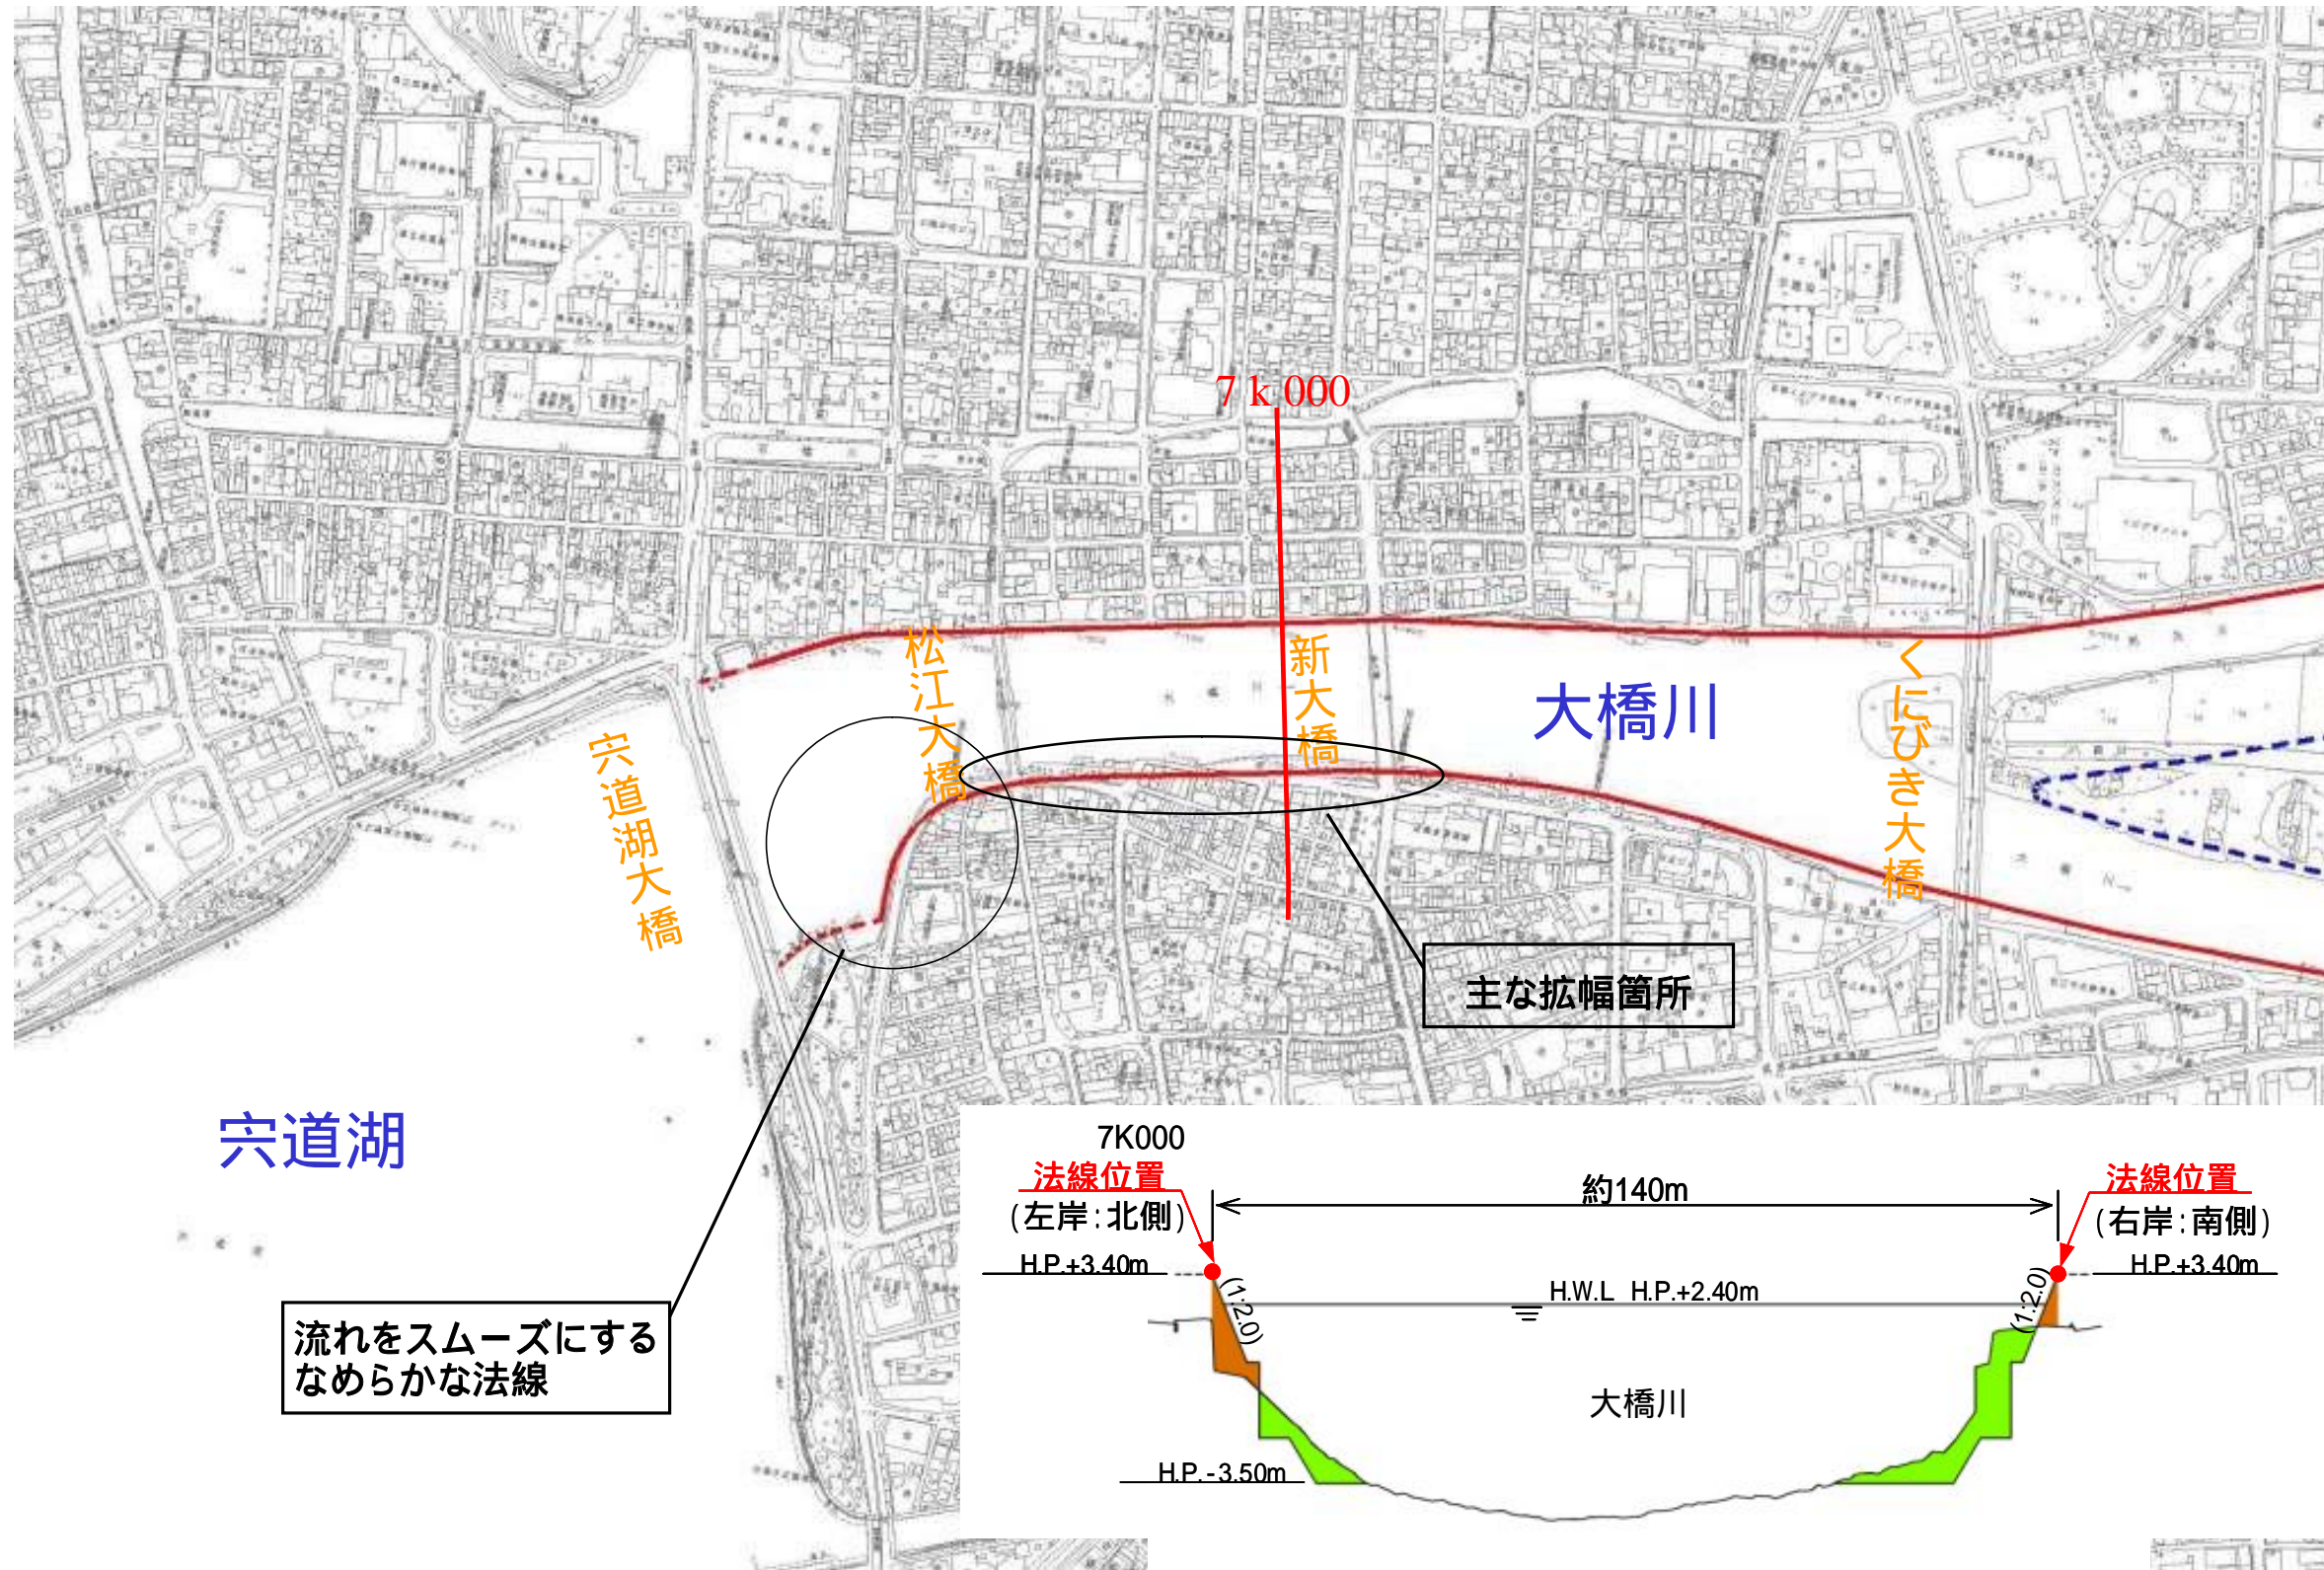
(2) 大橋川改修案の平面図・横断面図(上流部)
